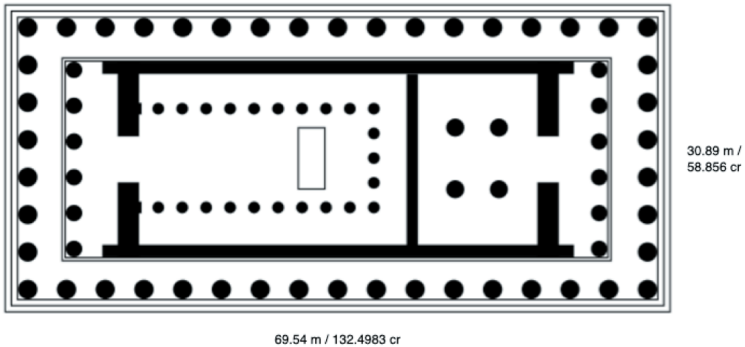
Planta del Partenón. Sostenido en su perímetro por 48 columnas
